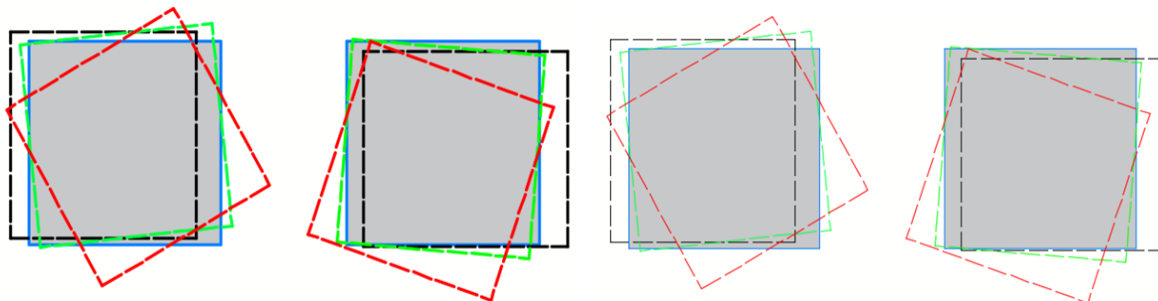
Схемы горизонтальных деформаций покрытия платформы в плане на 4 и 5 этапах испытаний
